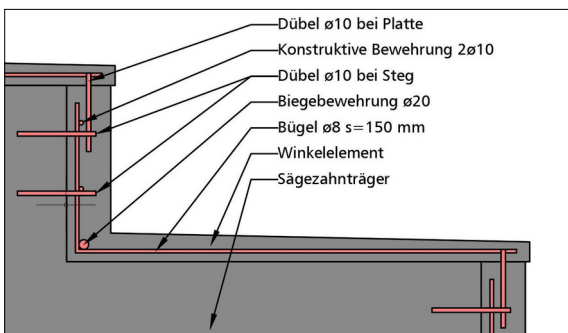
Winkelelement mit Bewehrung, Verbindungsmittel und Verankerung im Sägezahnträger
